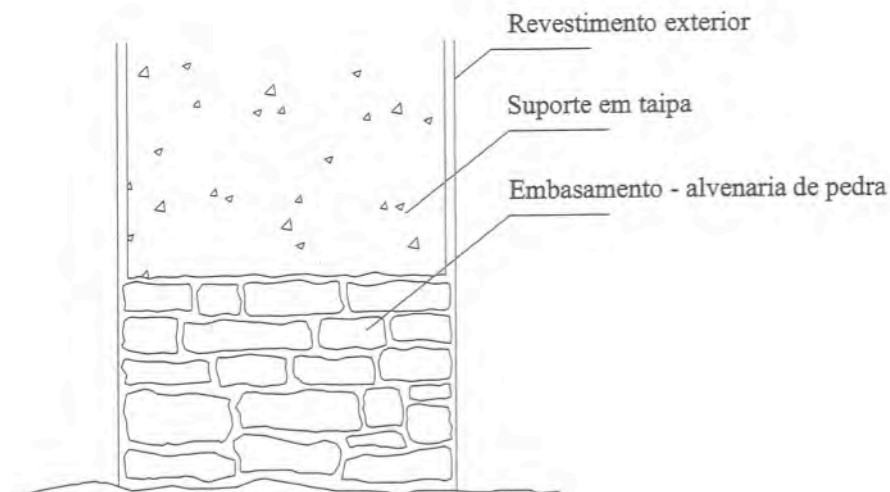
Sistema típico de ligação da parede de taipa ao solo de fundação. Caracterização de revestimentos usados em construções de taipa no barlavento algarvio. (Mateus, 2006, p. 16)
